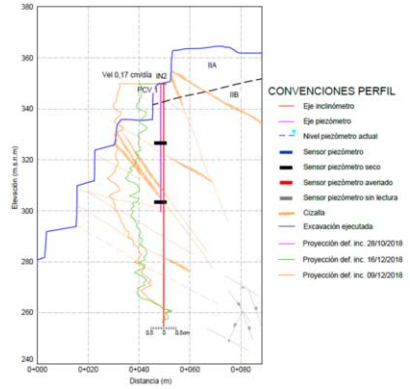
Comportamiento de inclinómetros y piezómetros de la zona norte, perfiles longitudinales.
